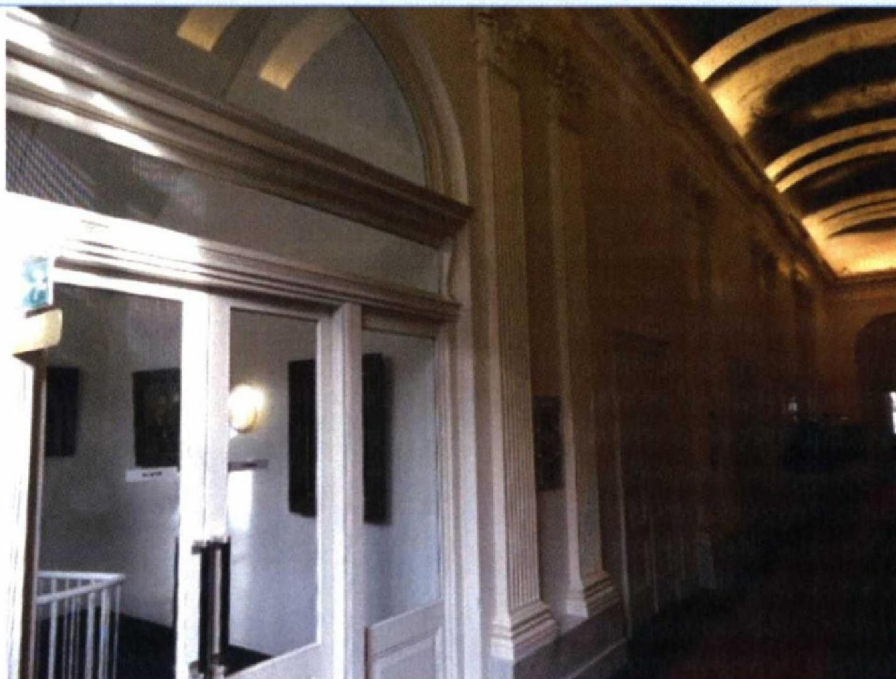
Kamer van de burgemeester. Scheuren in stucwerk. Scheuren uitkappen en loszittend stucwerk verwijderen. Scheur in achterliggend metselwerk herstellen met mortel van gelijke structuur en samenstelling als het omringende metselwerk. Wapeningsgaas aanbrengen en stucwerk en sauswerk herstellen.
